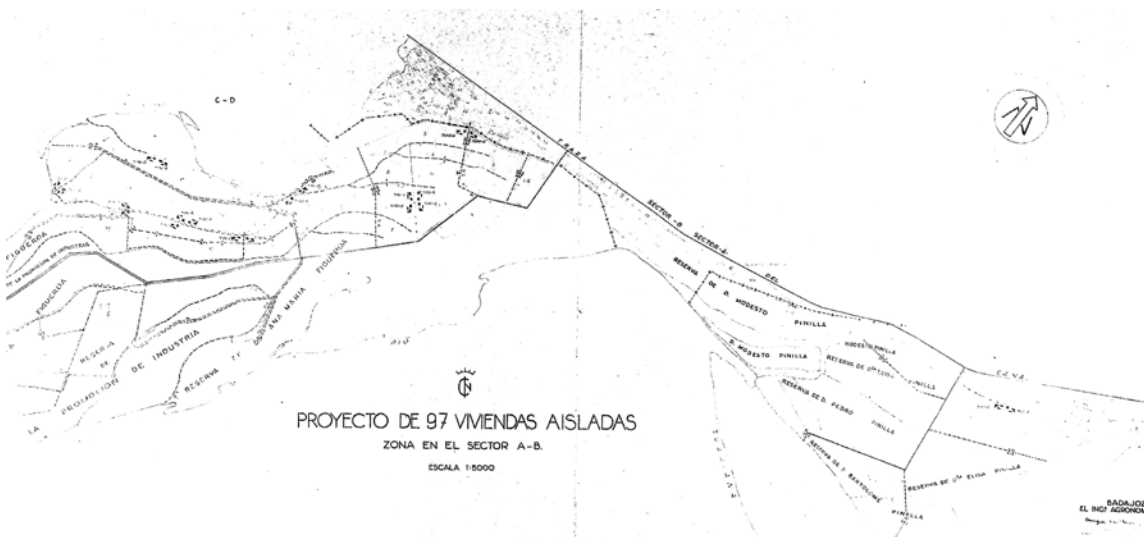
Plano de Ordenación para Proyecto de 97 Viviendas Aisladas en la Zona del Sector A-B del Canal de Montijo (1957). Fuente: Mediateca MAPAMA.
